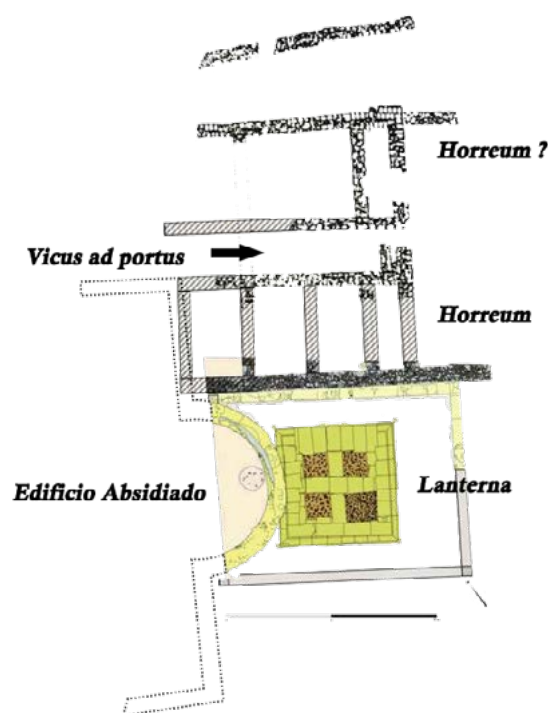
Planimetría con interpretación de los restos de calles Palos-Tres de Agosto.
